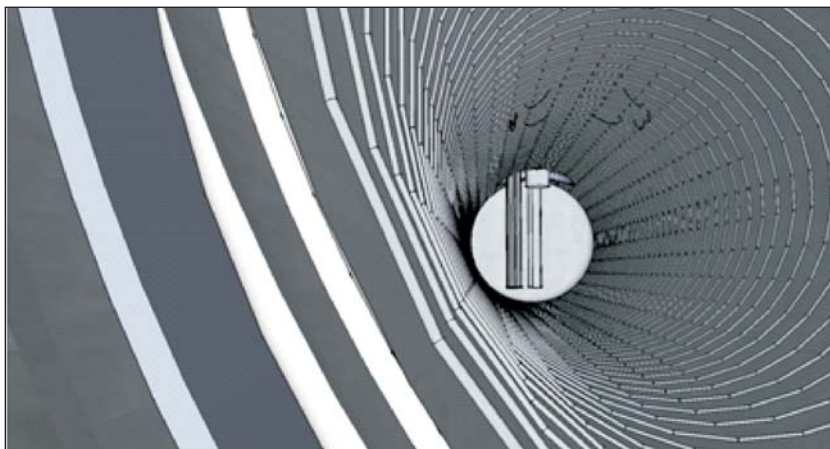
Защитное покрытие (навивка проволоки) внутренней стенки резервуара
